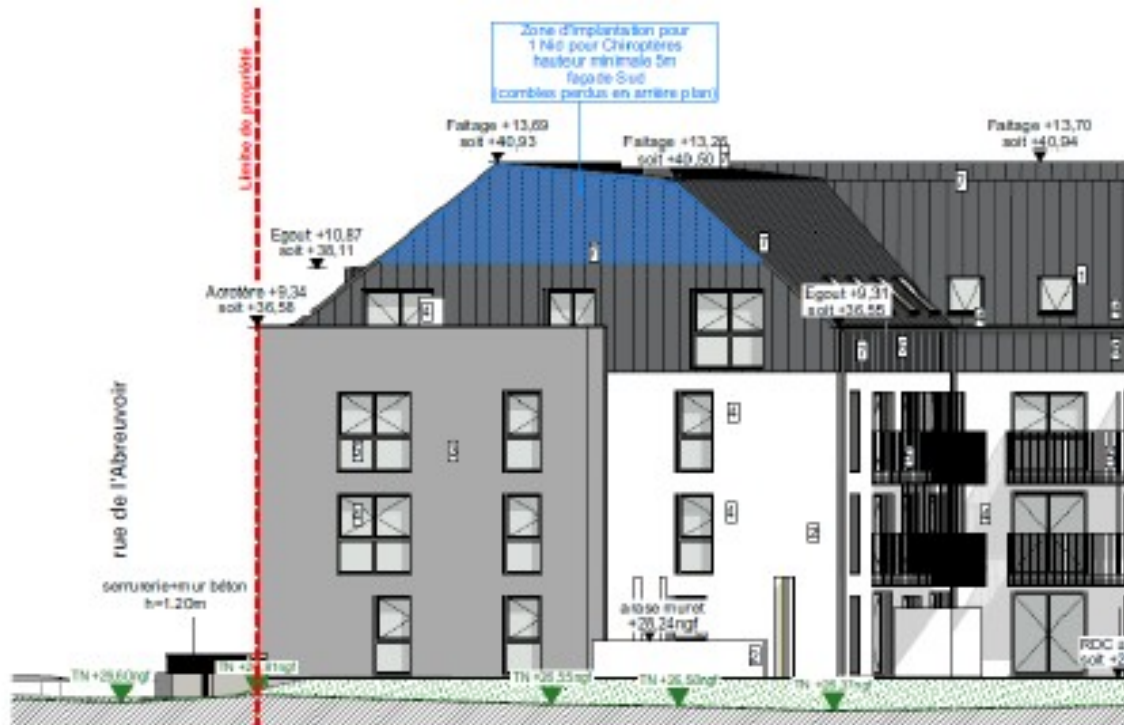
Zoom du plan de façade sud localisant les mesures d'accompagnement - PRISM architectes associées
